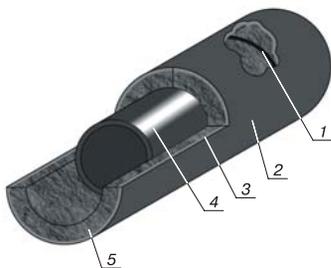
Теплоизоляция трубопроводов: 1 – стяжка; 2 – кровельный слой; 3 – гидроизоляционный слой; 4 – труба; 5 – «Эволит-термо»
